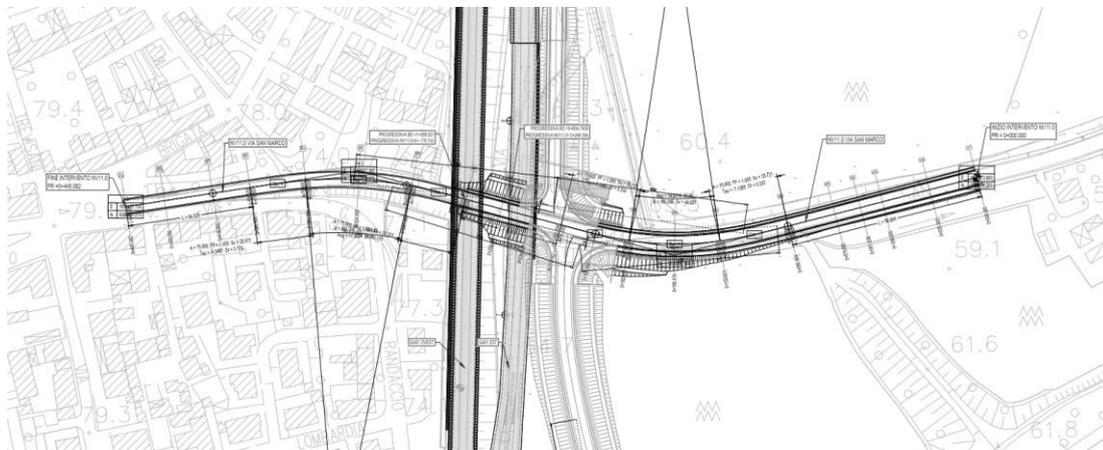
NV11 – Stralcio planimetrico su rilievo Via San Marco.
